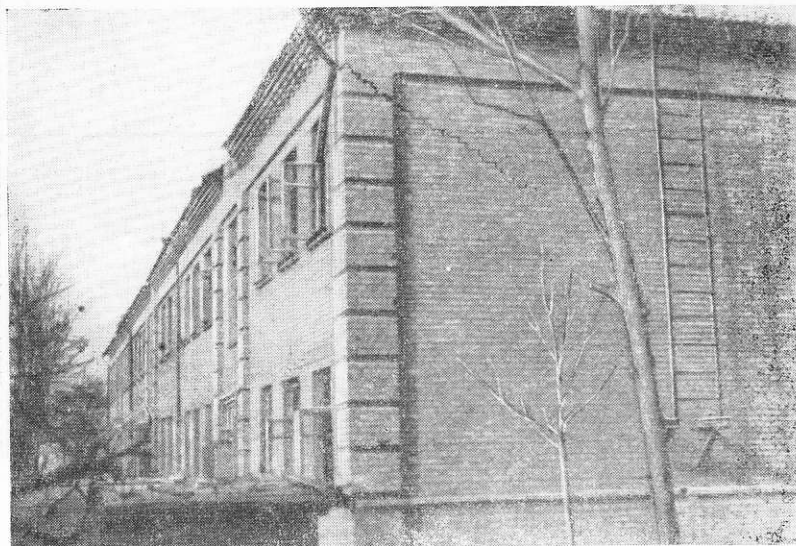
Дворовый фасад двухэтажного кирпичного жилого дома. Конструкции стен и карниза решены без выступающих элементов
